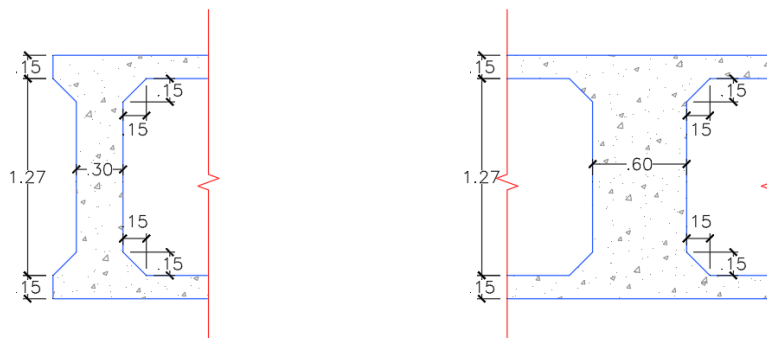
Sección de Vigas Diafragma en el eje longitudinal del Puente Nochoz; (Izquierda) Sobre Estribos, (Derecha) Sobre el Pilar
